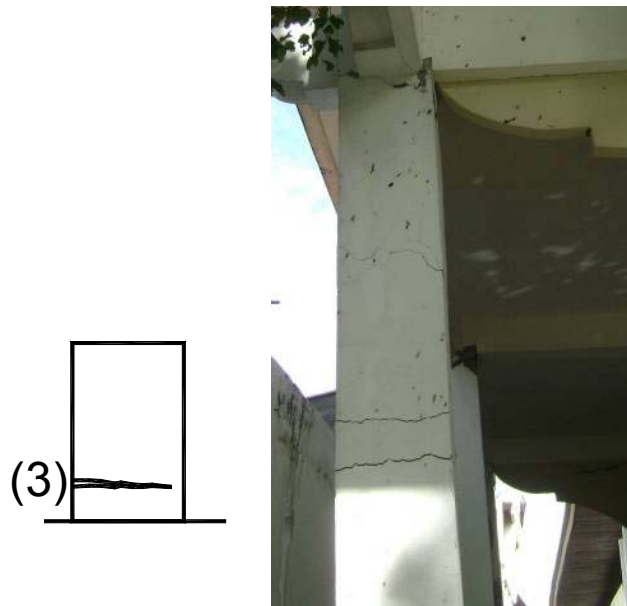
Grietas por flexión: a) esquemático; b) en columnas
